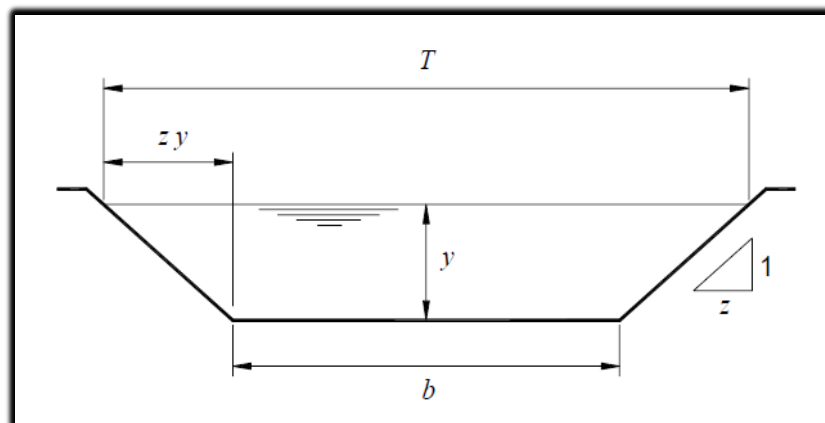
Sección transversal de un canal trapezoidal (Rocha, 2002.)
